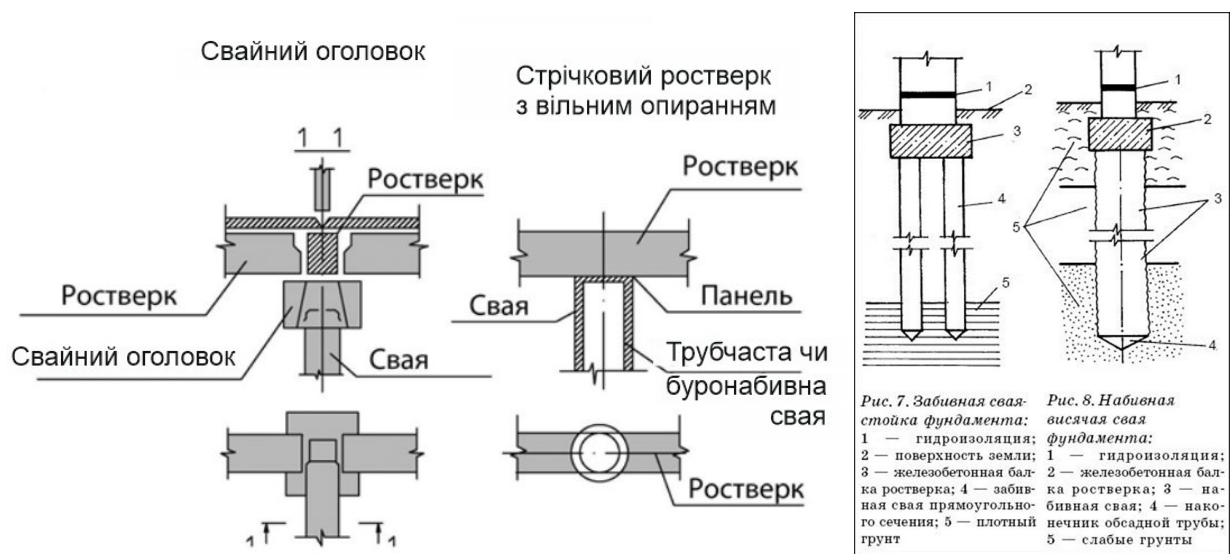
Схема влаштування збірних залізобетонних та монолітних ростверків у паливих фундаментах
